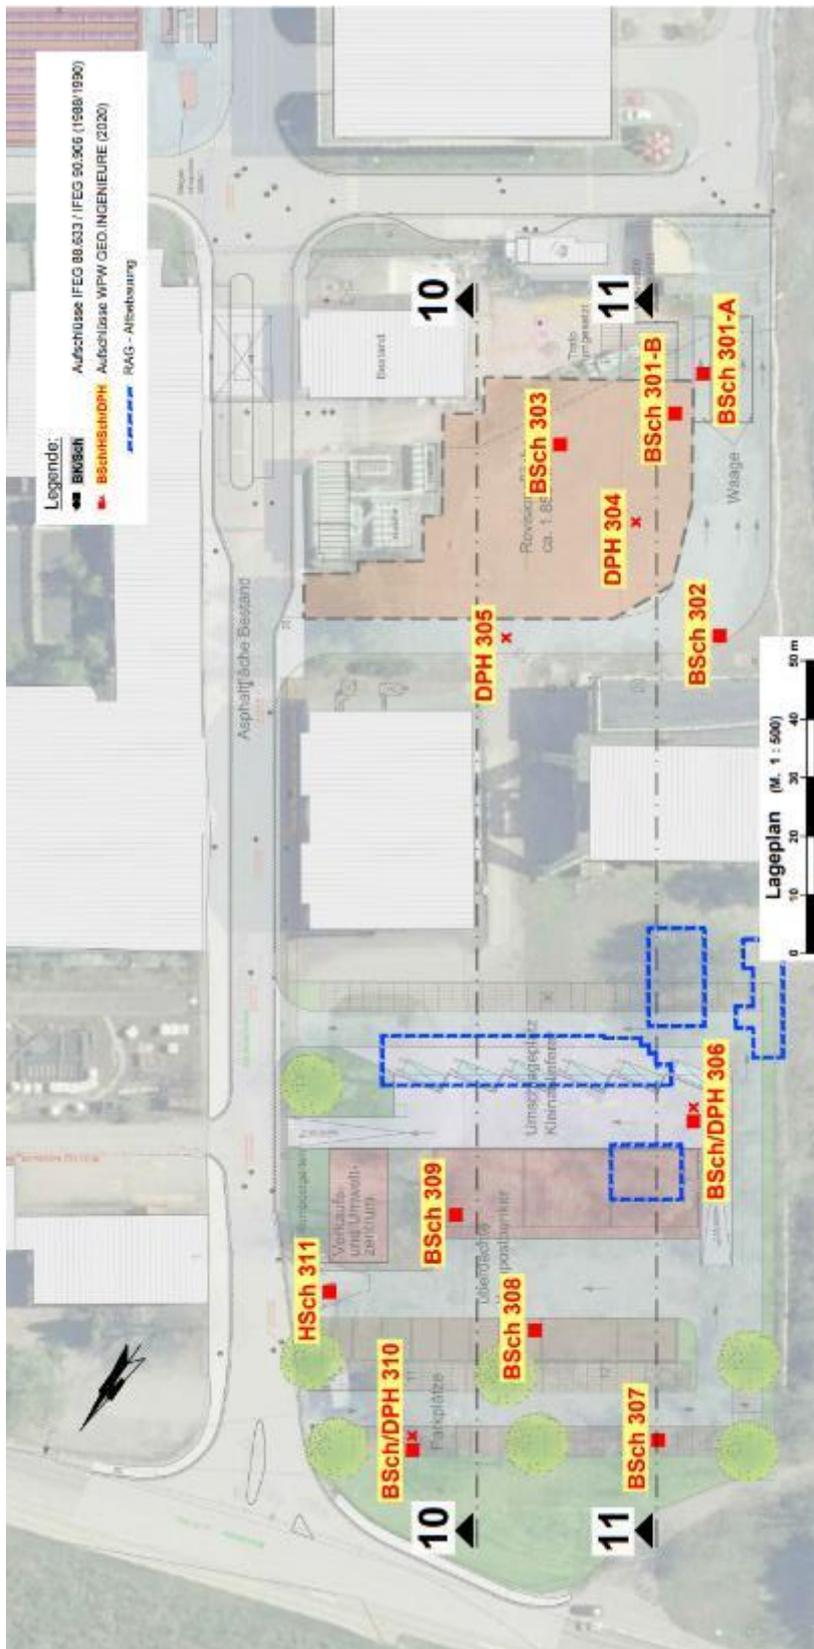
Übersichtslageplan - Baugrunduntersuchung 2/2
